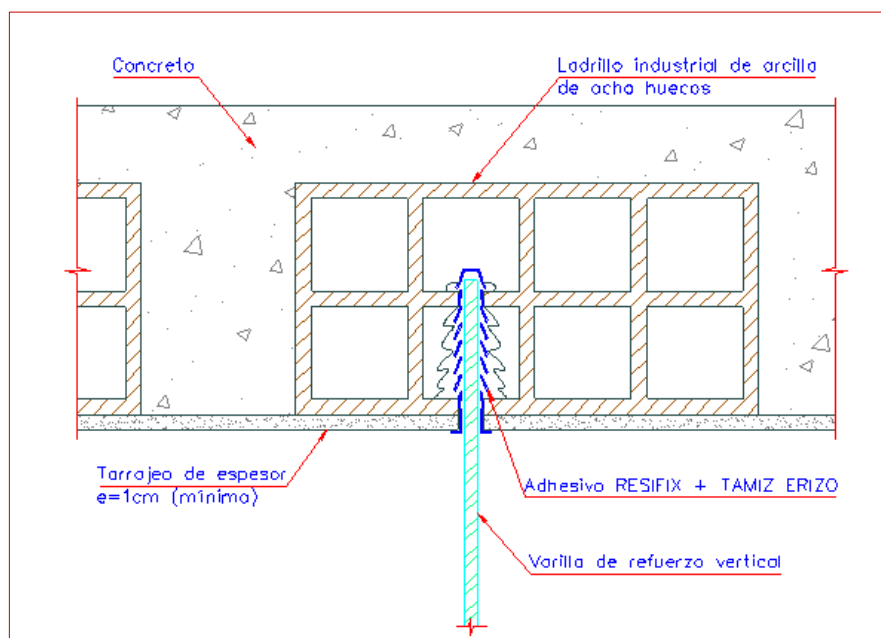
ANCLAJE SUPERIOR DE VARILLAS A LADRILLO DE TECHO EN TABIQUERÍA ADOSADA
